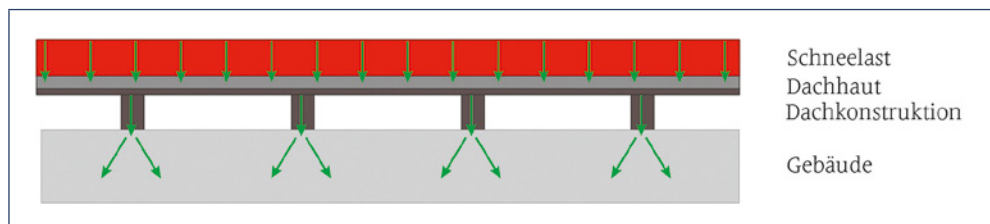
Schema Lastabtragung eines Sparrendaches mit gleichmäßiger Sparrenbelastung
